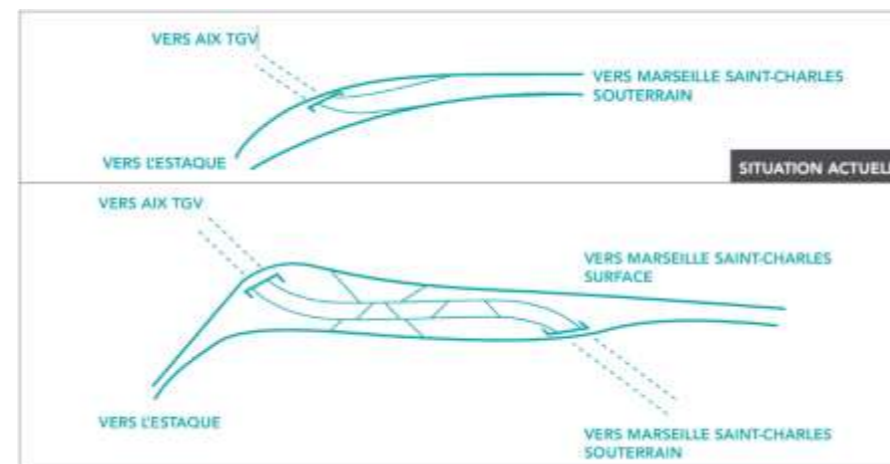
Schéma du raccordement d'entrée en tunnel au droit de la Delorme (dossier de concertation 2021)
